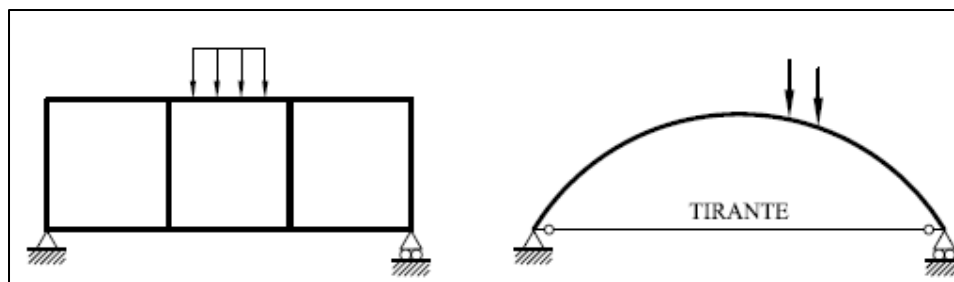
Estructuras exteriormente isostáticas - interiormente hiperestáticas
